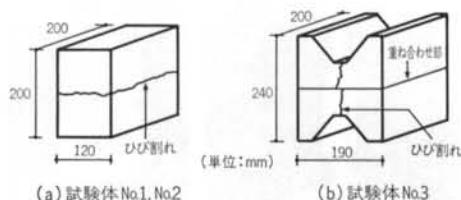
ひび割れ部の注入試験に用いたコンクリート(単位:mm)
